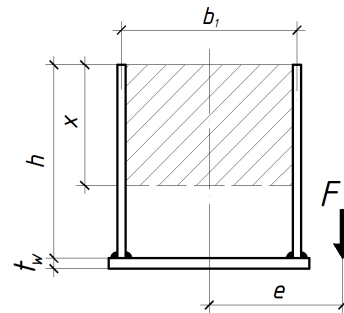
Розрахункова схема поперечного перерізу сталезалізобетонного ригеля / Cross-section of the composite steel concrete beam
